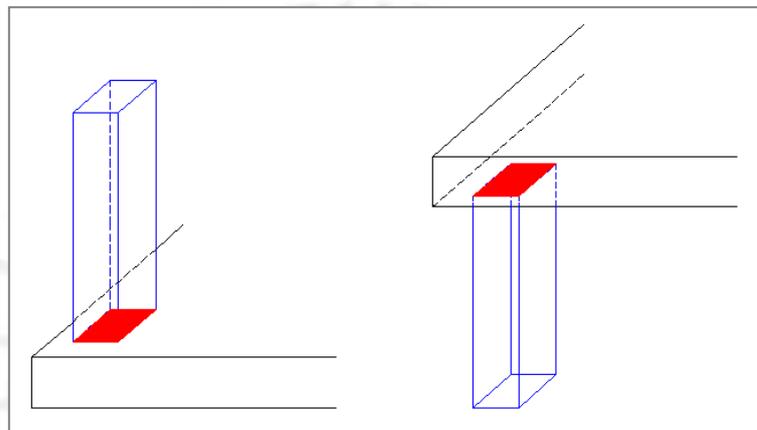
Encuentro entre losa y columna (y viceversa). Zona muy común de almacenamiento de desperdicios.
